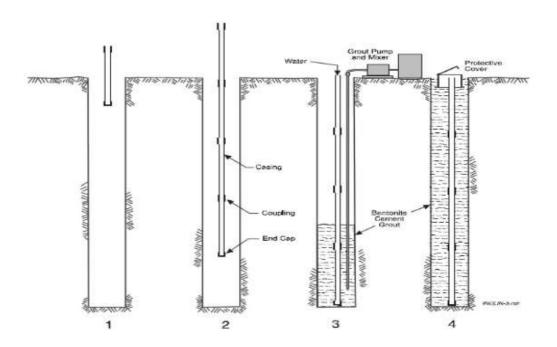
IV.3.5 Detalle de la instalación de un inclinómetro. Fuente Us Army Corps of Engineers USACE, 2009.
